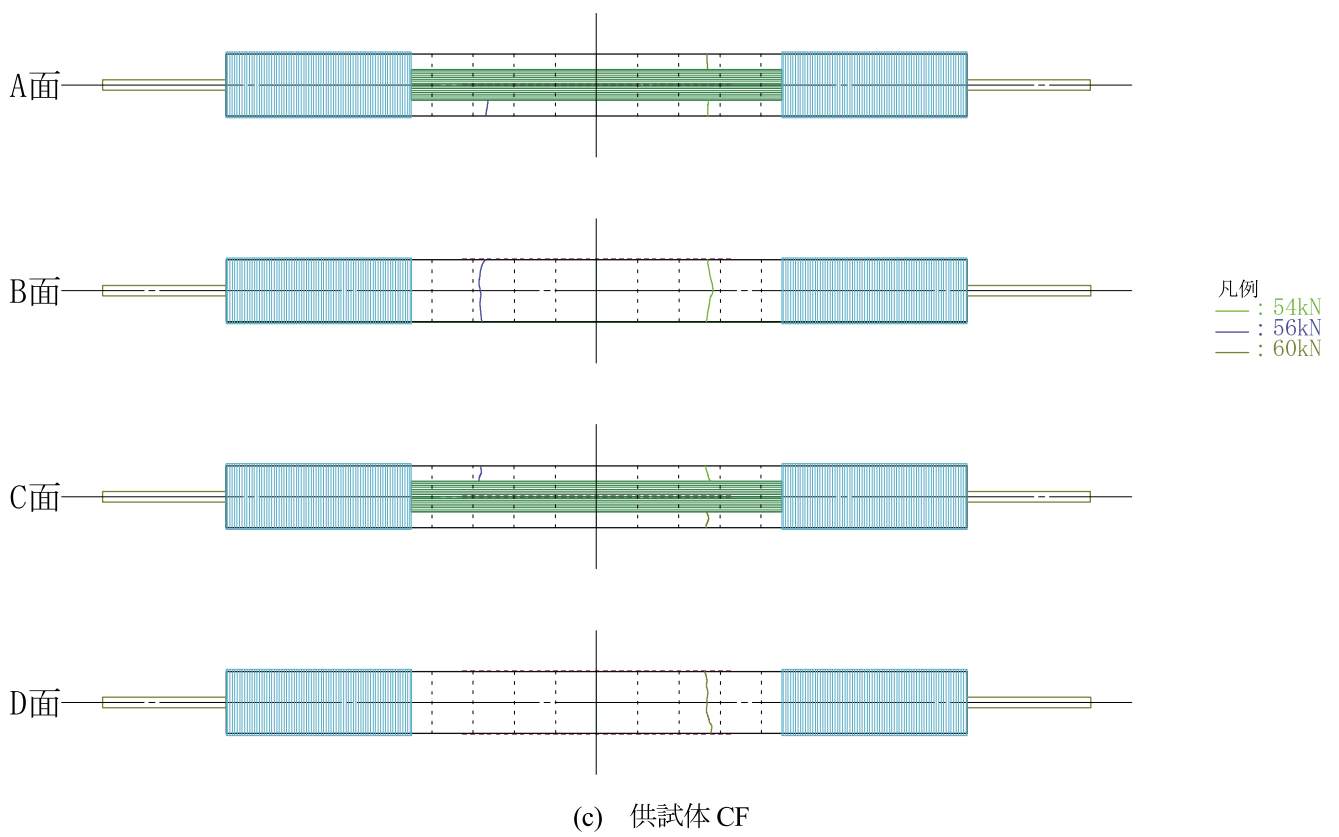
ひび割れ発生時におけるコンクリートのひび割れ発生状況（つづき）
